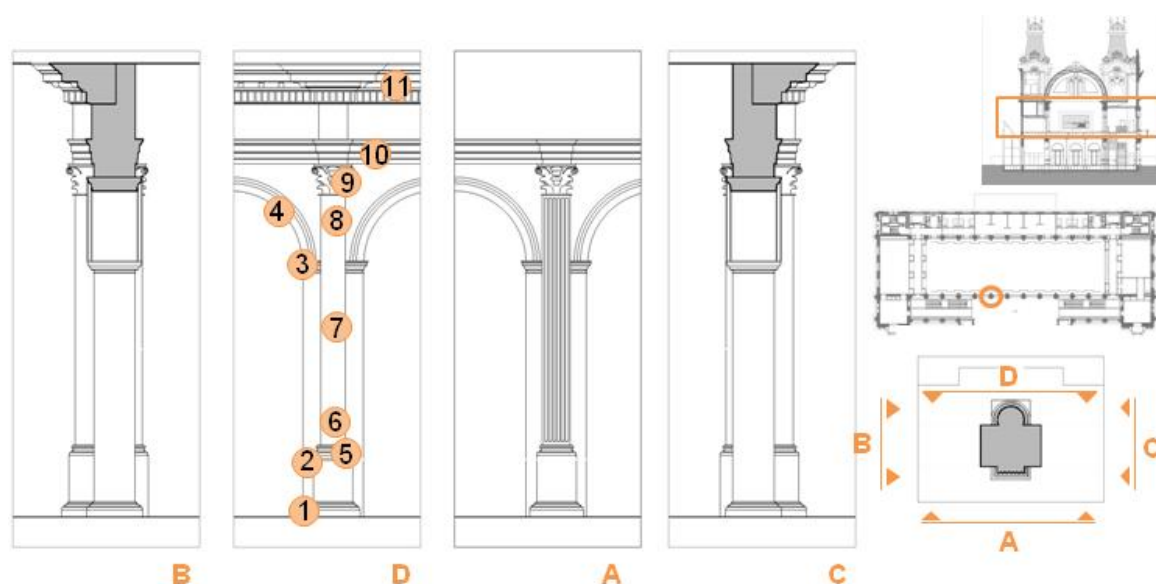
Ejemplo de la numeración de las piezas prefabricadas de uno de los pórticos de la sala de la primera planta
